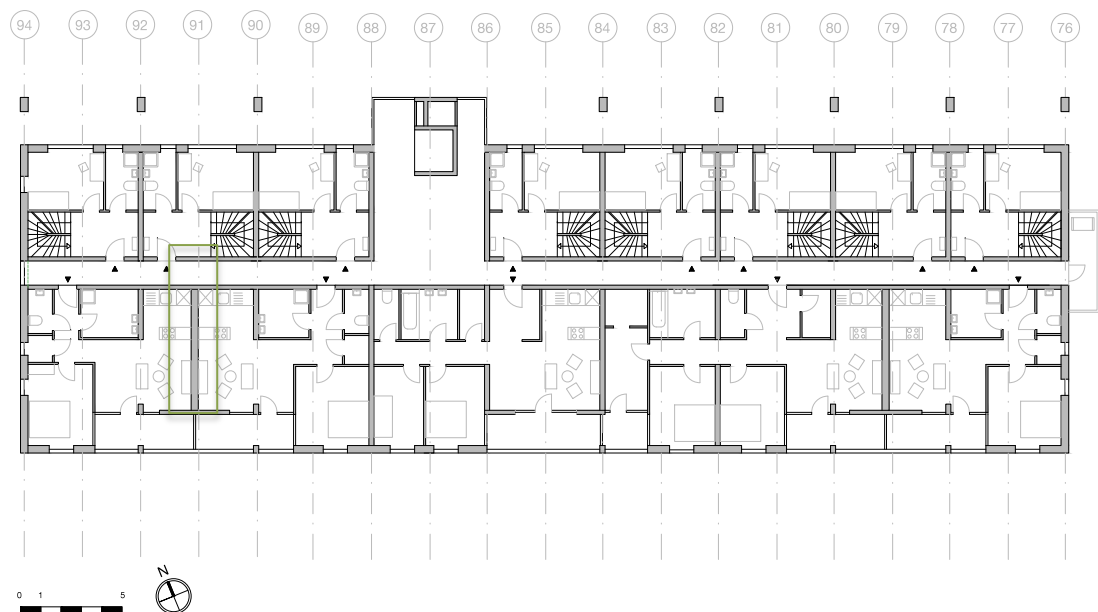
Grundriss eines Regelgeschosses mit ausgewählter Innenwand
